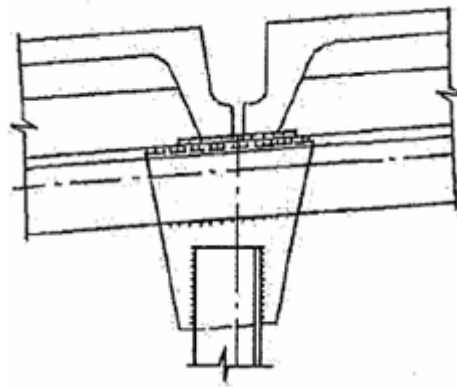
Вузли обпирання на ферму залізобетонних плит
